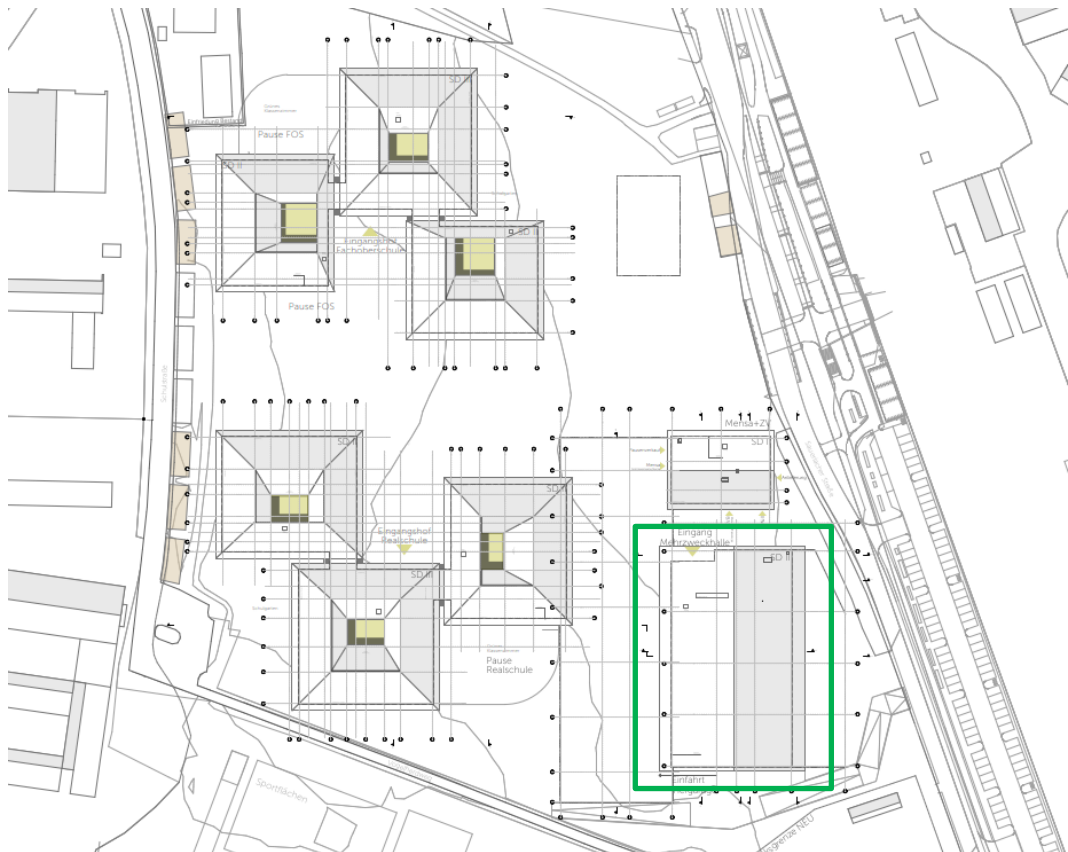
Ausschnitt aus dem genordneten Lageplan, Mehrzweckhalle grün markiert.
